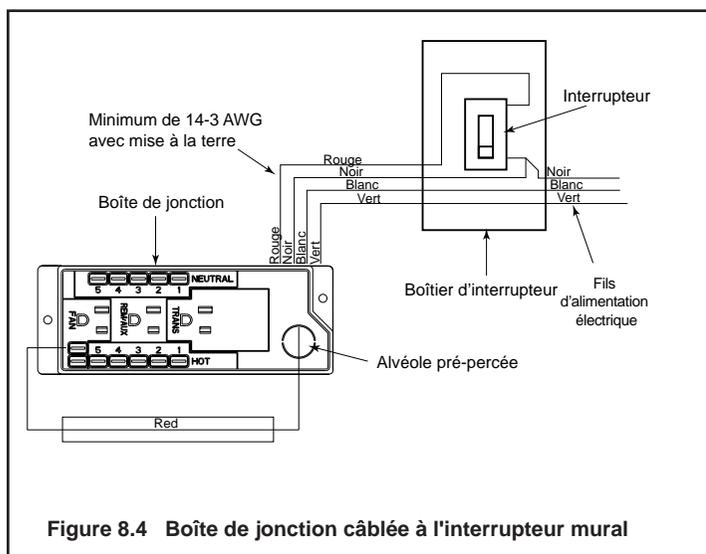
Boîte de jonction câblée à l'interrupteur mural
